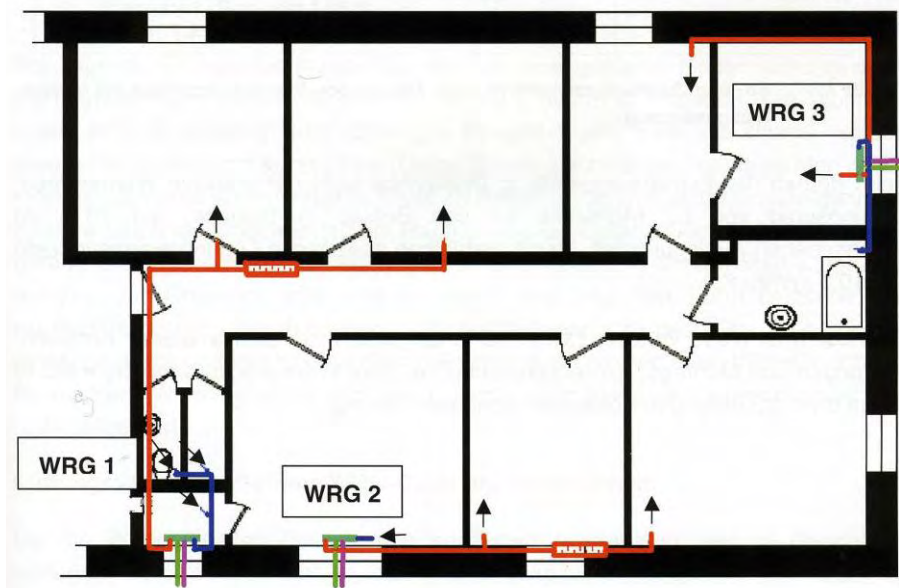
Anlagenkonzept (dezentral, Einzelraumgeräte) im Grundriss
